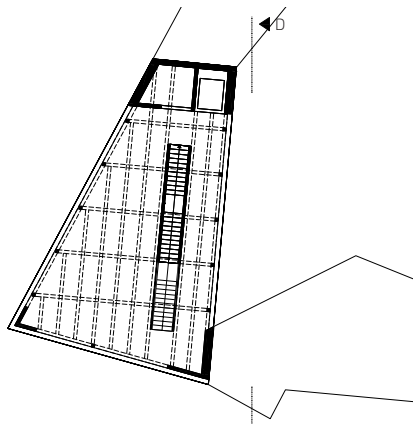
Grundriss Gewächshaus 2.OG +13,40m
